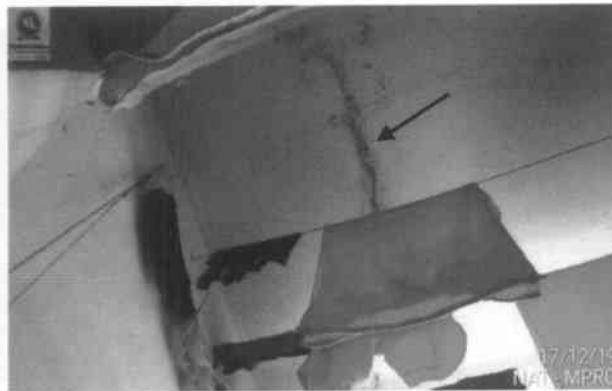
Pavilhão Vivência – celas com trincas e grande infiltração na laje.
